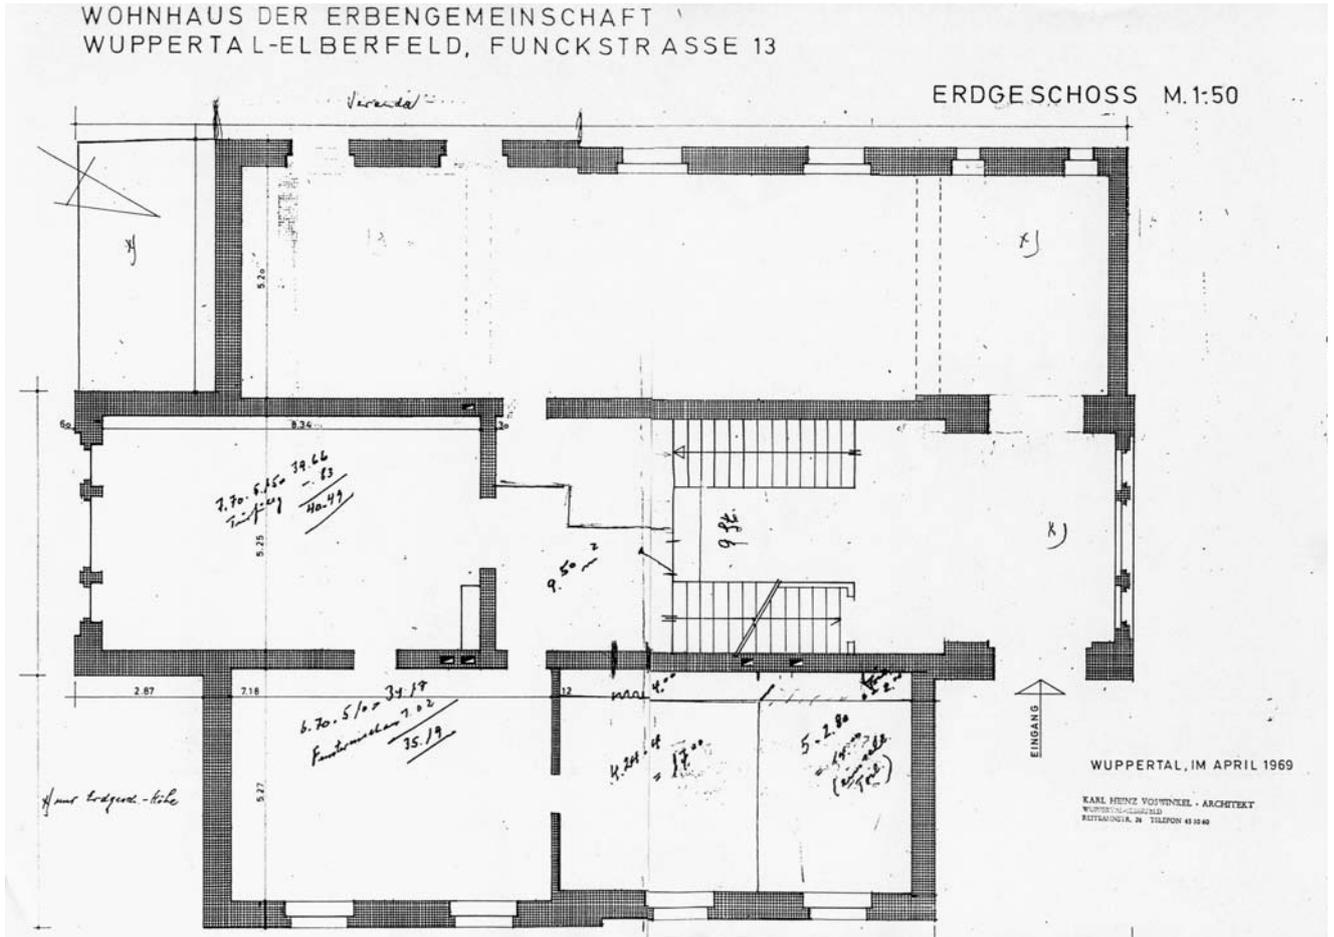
Haus Wolff, Grundriss Erdgeschoss, angefertigt durch den Architekten Voswinkel, 1969
